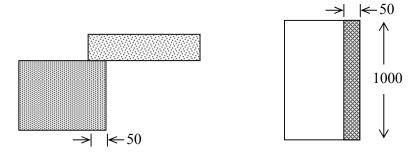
Sambungan Plat Pracetak dengan Balok Pracetak
